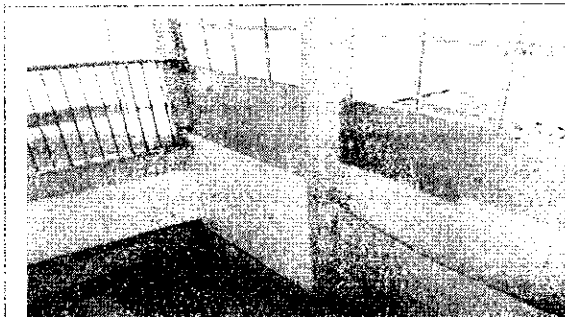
Vista de las escaleras de acceso a la segunda planta de la edificación en la parte frontal.
